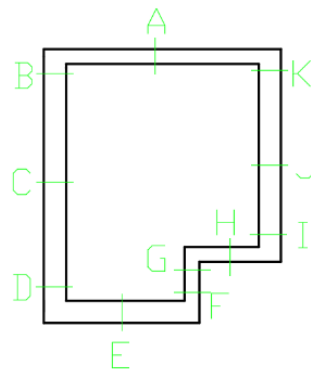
Galeria de acesso a céu aberto. Secções de dimensionamento
